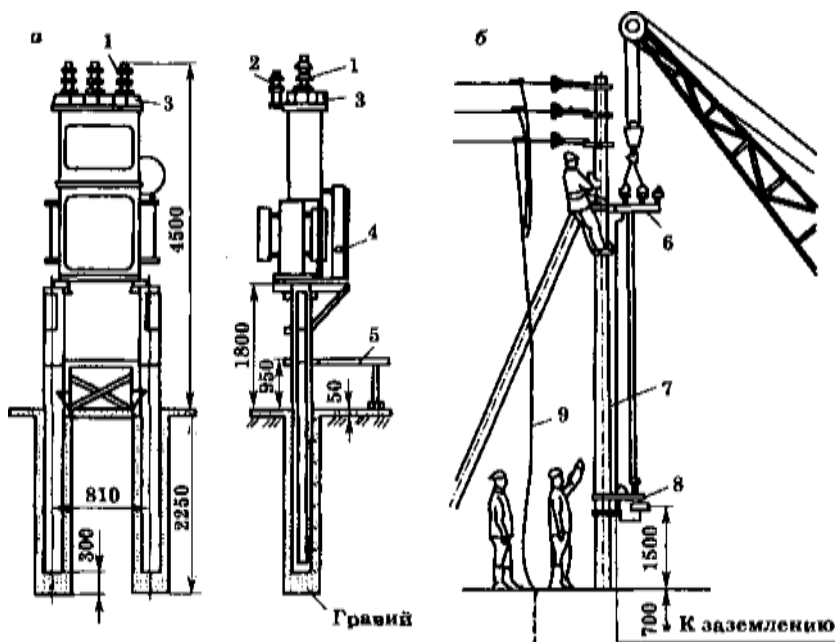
Монтаж КТП и разъединителя: а — нормируемые установочные размеры; б — монтаж разъединителя 10 кВ; 1 — проходные изоляторы 10 кВ; 2 — разрядники; 3 — изоляторы 0,38 кВ; 4 — фотореле; 5 — площадка; 6 — разъединитель; 7 — заземляющий проводник; 8 — привод; 9 — переносное заземление
